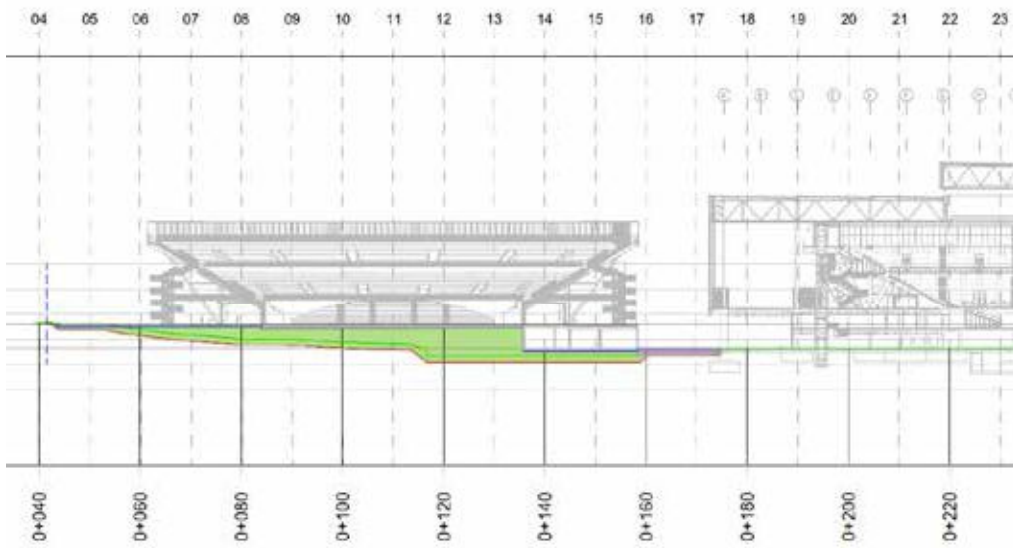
Sección longitudinal de excavación y rellenos a partir del eje de apoyo
